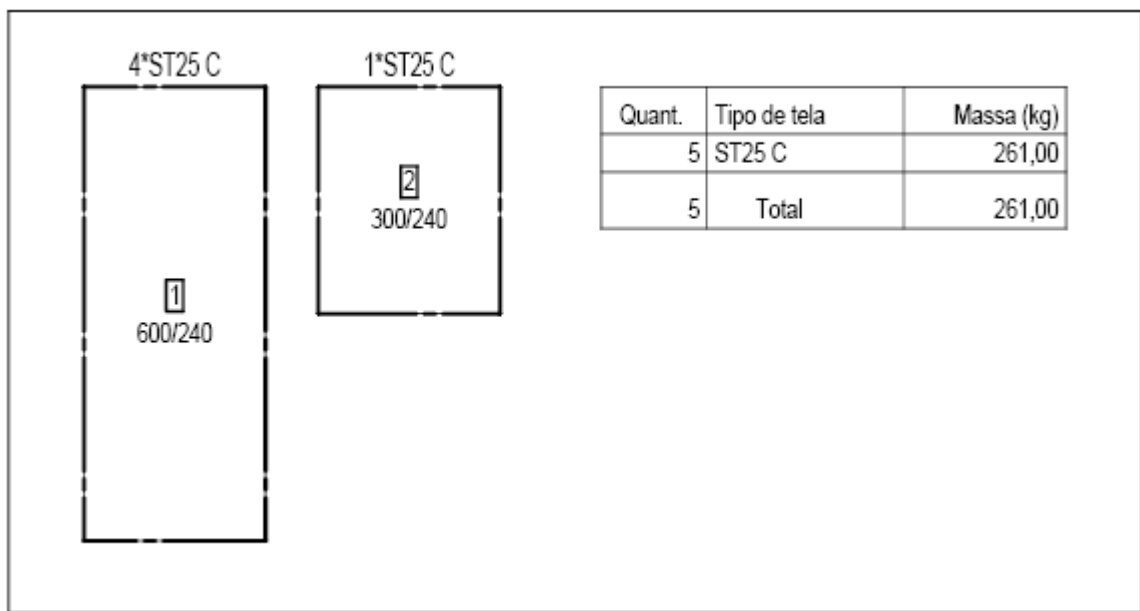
lista de telas soldadas do tipo ST 25 C
